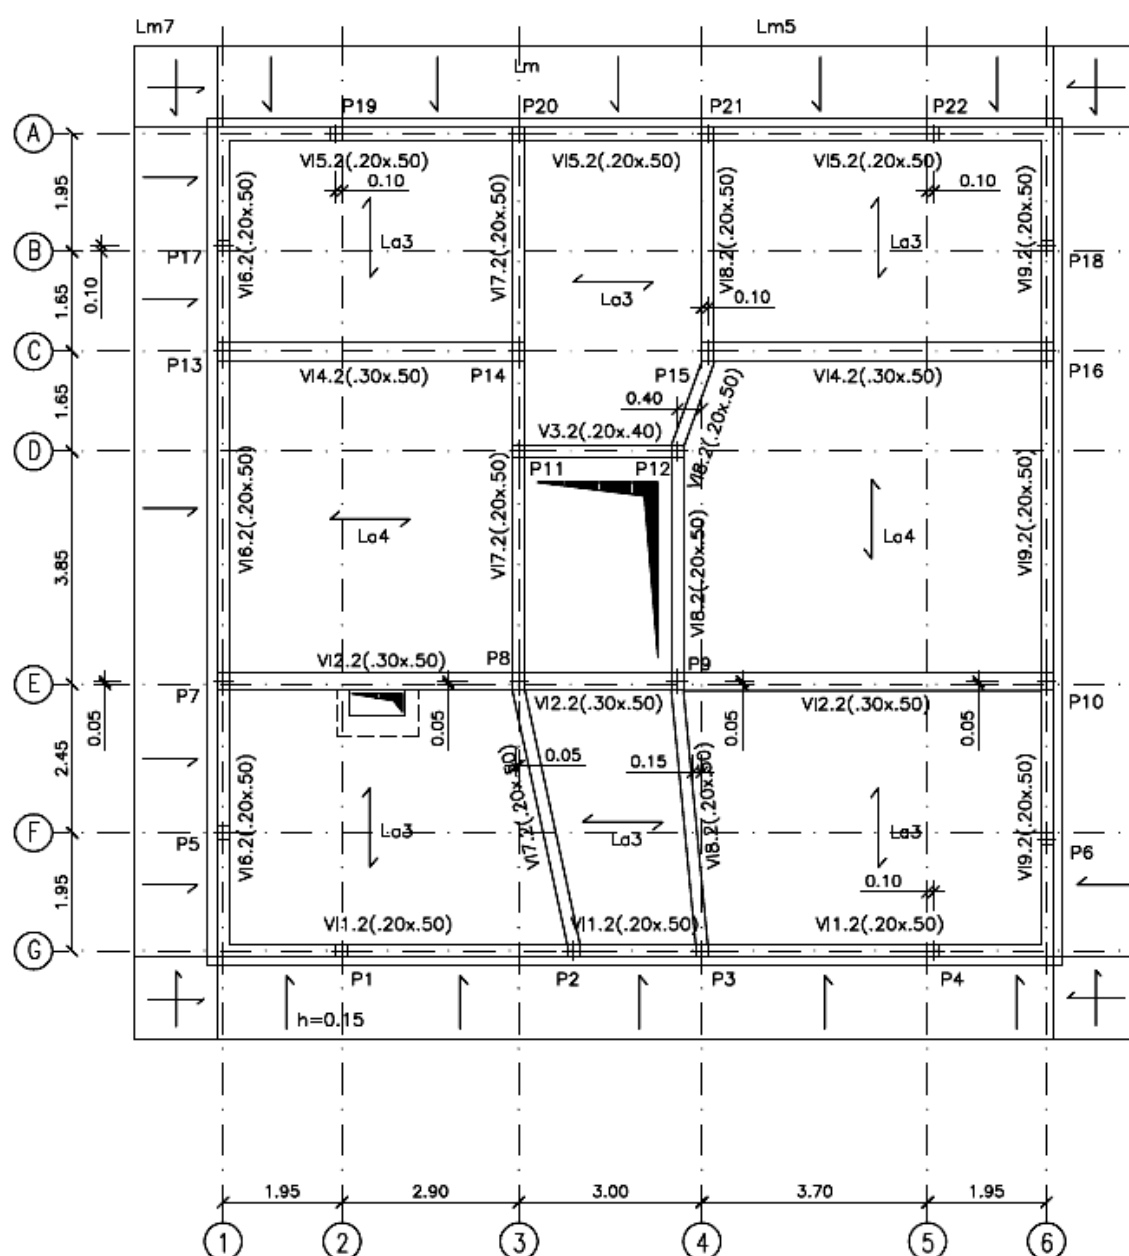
Planta estrutural dos Pisos 1 a 3.
